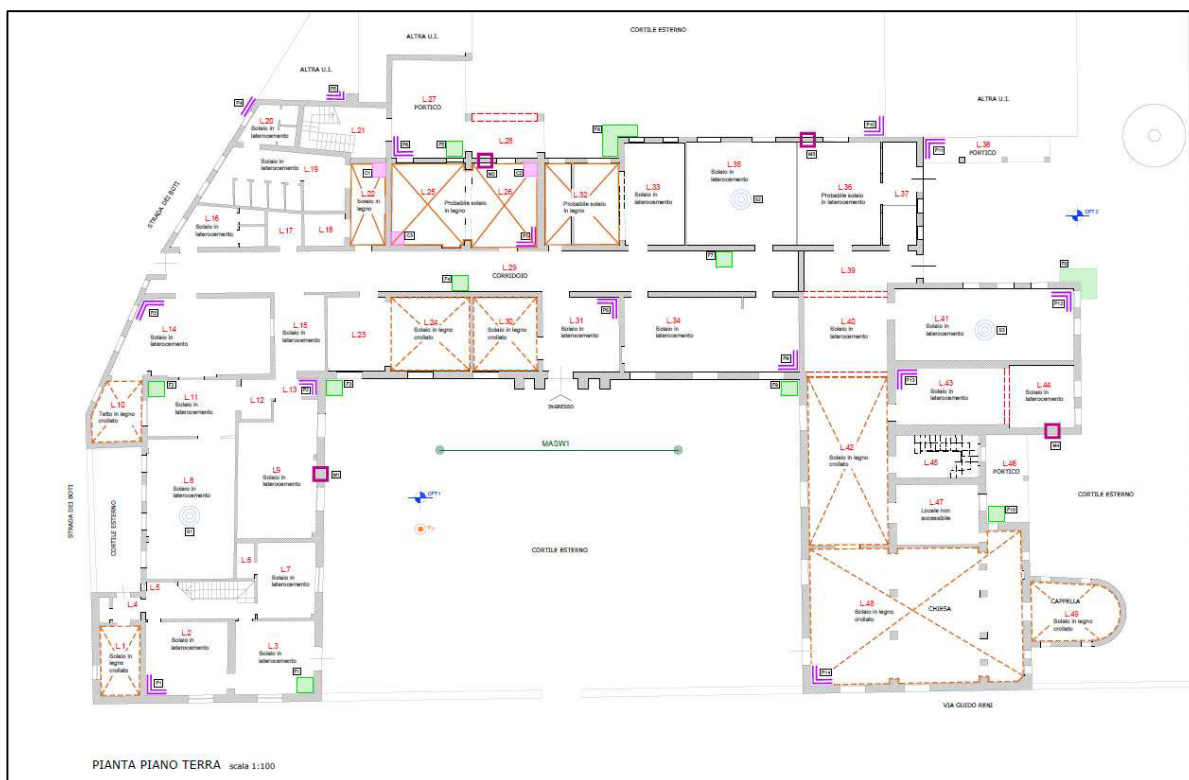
Planimetria con area di indagine e ubicazione di progetto dei punti (in blu e verde)
